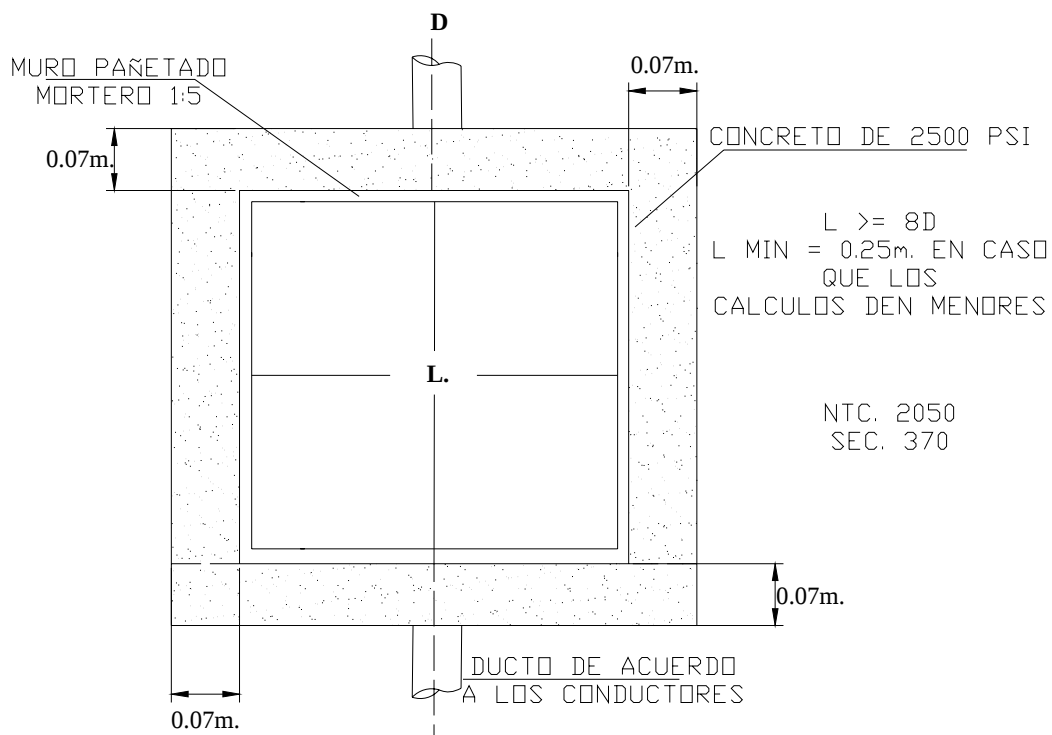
Caja de inspección sencilla en BT. Vista de planta.
